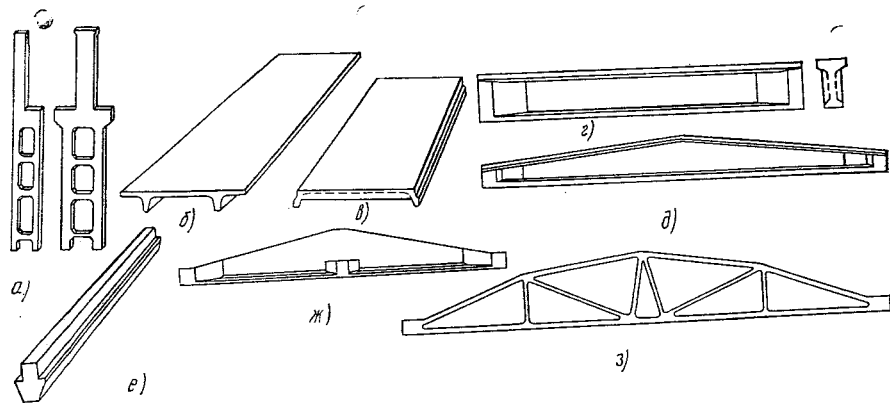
Схемы основных железобетонных изделий для промышленного строительства:
